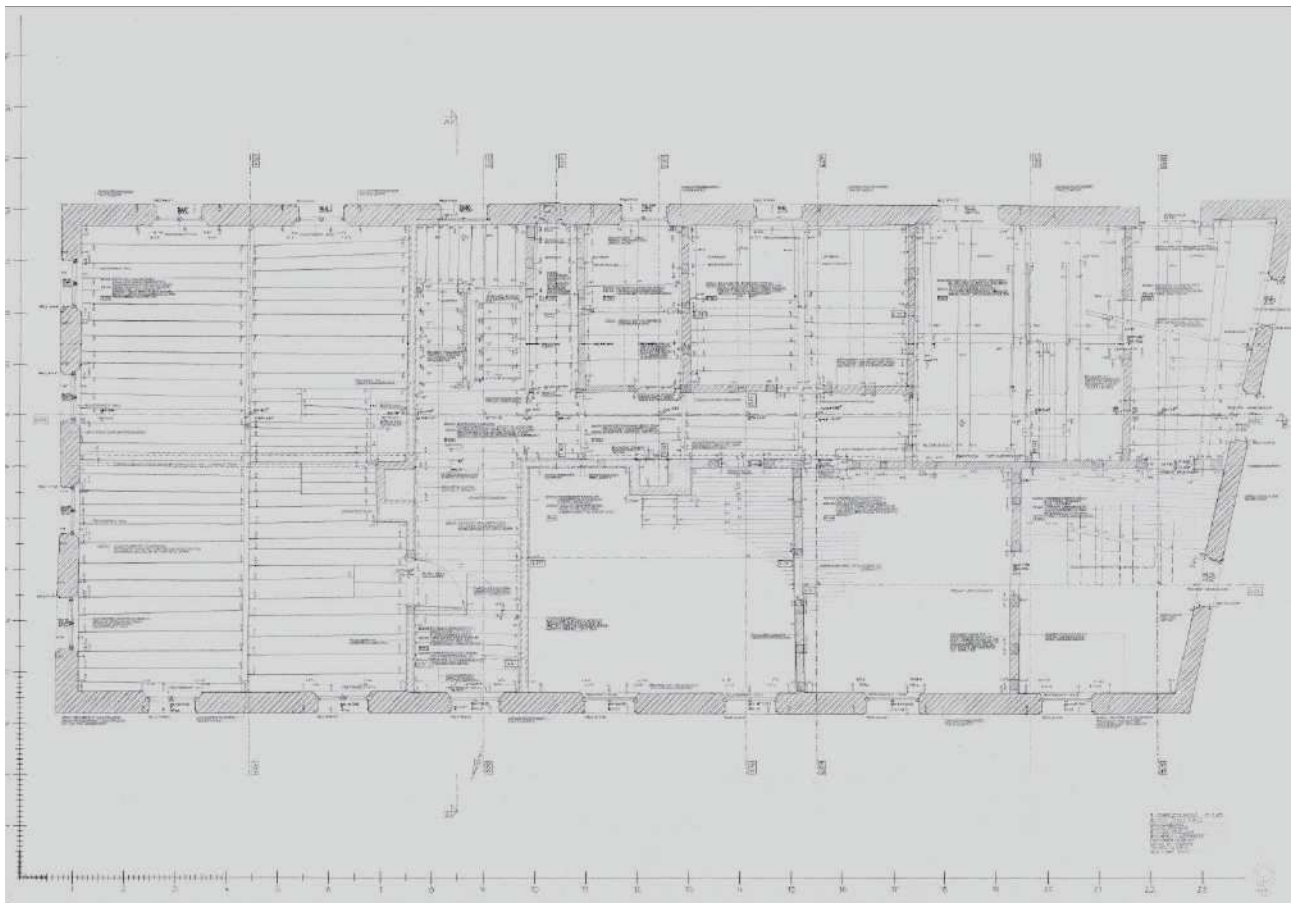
Bestandsplan des alten Landschulhauses, Obergeschoss, 2003
